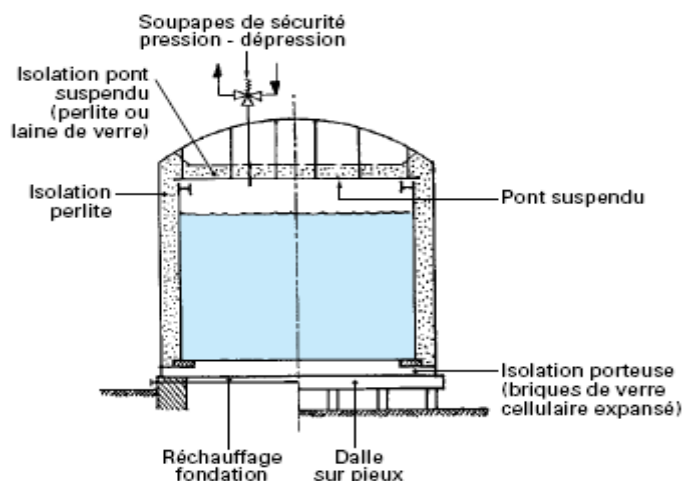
Réservoir à double paroi métallique avec toit dôme et pont suspendu.
